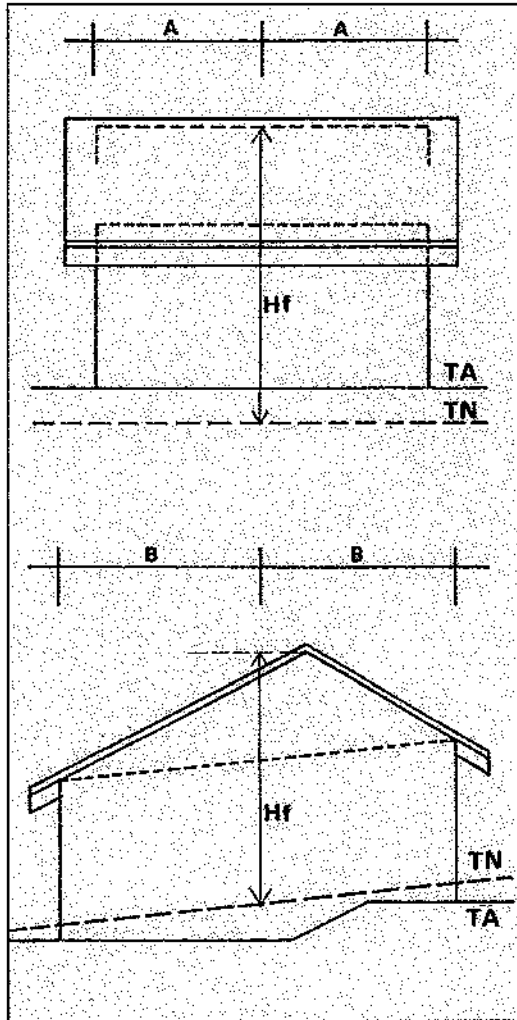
Hauteur de bâtiment différencié en plan et en élévation
